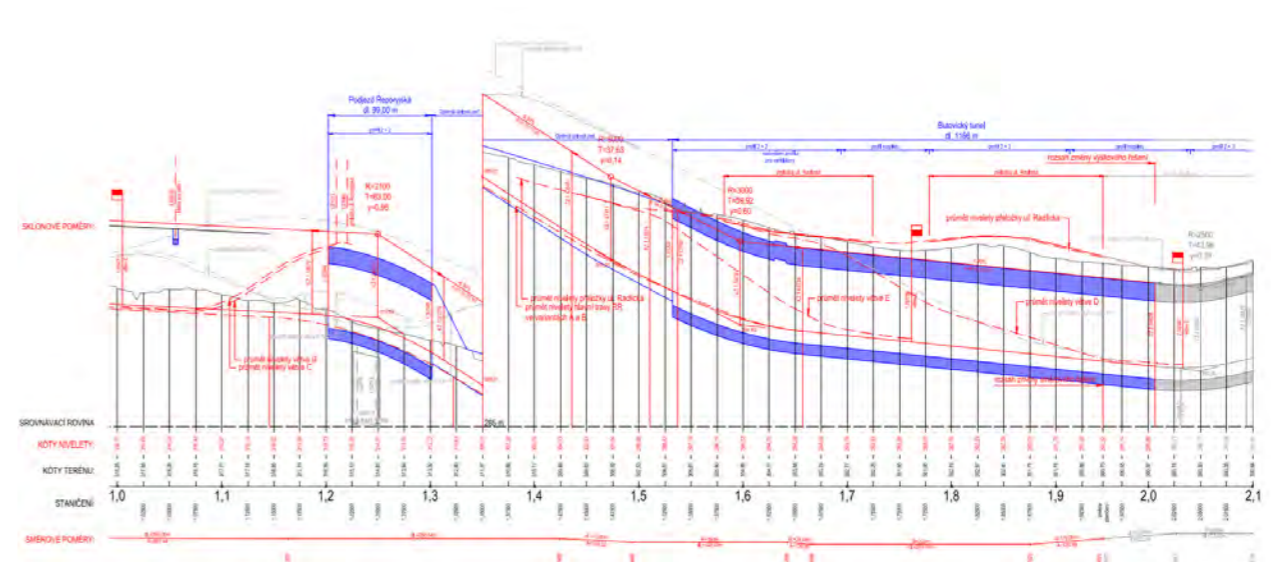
Úsek Botanica – podélný profil RR varianta B
